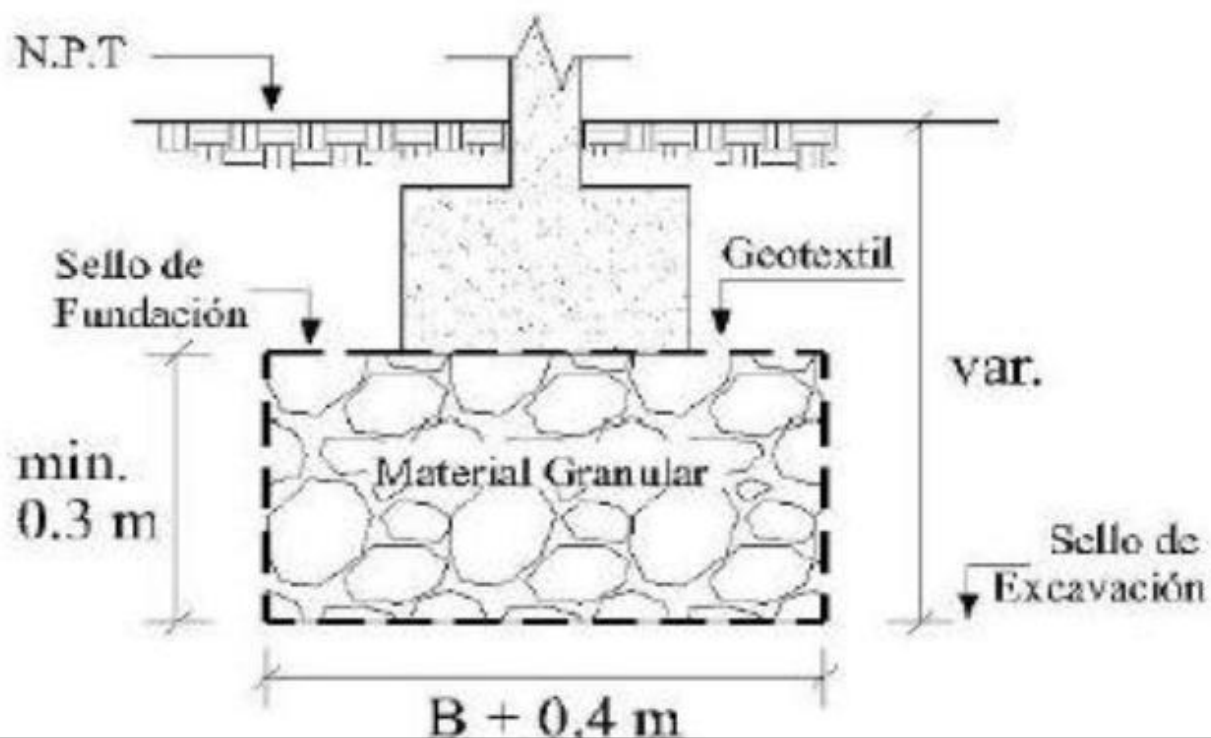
Esquema tipo de fundación aplicado a este proyecto.
